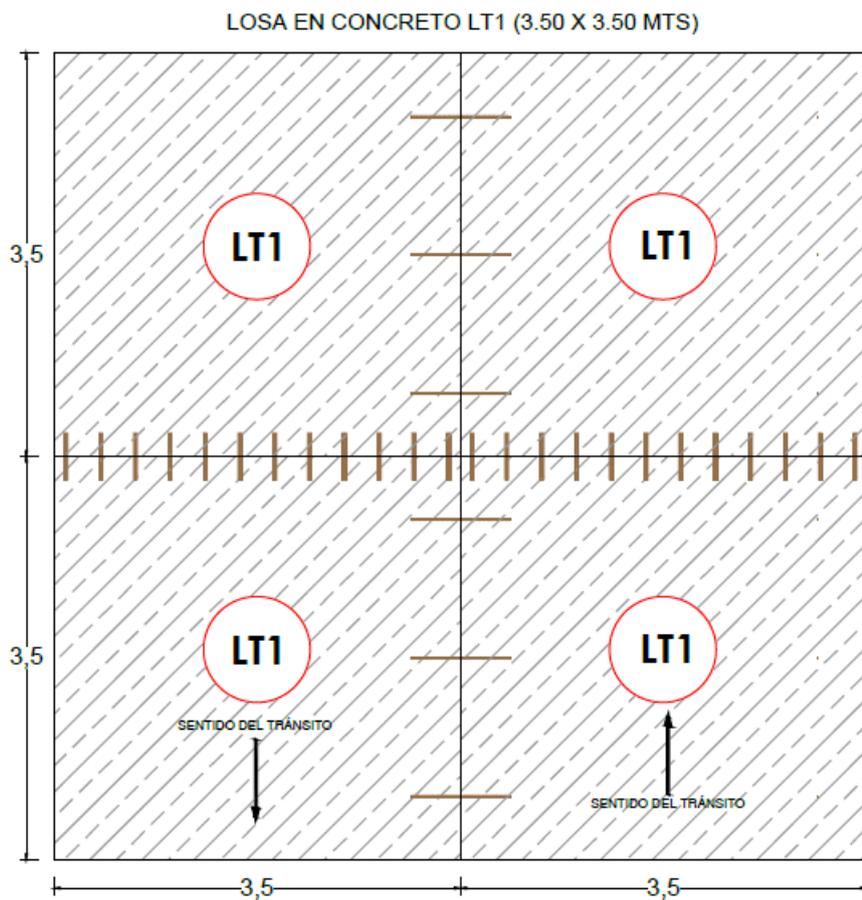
Detalle de la unión de las losas de concreto. Elaboración Propia
